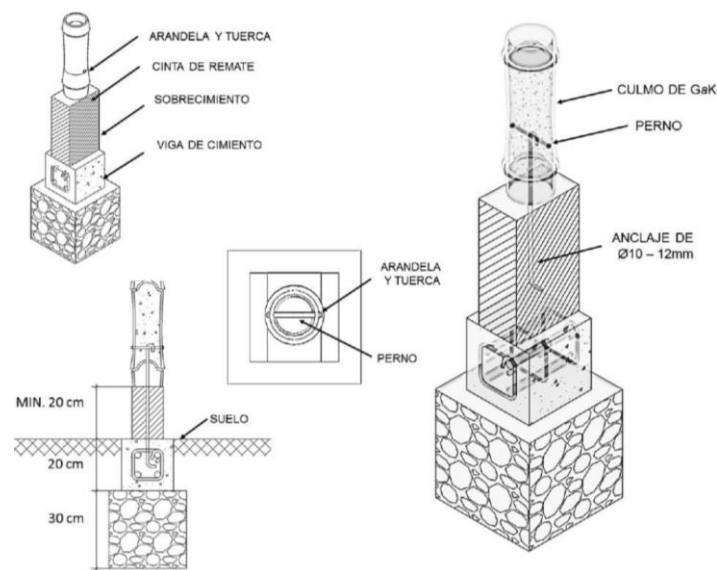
Detalle de apoyo de columnas de GaK en sobrecimiento
